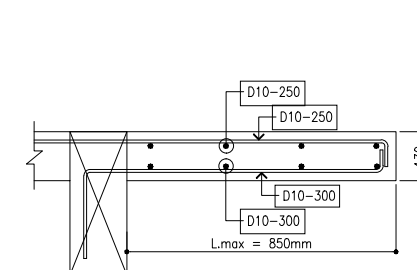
DETAIL PEMBESIAN SLAB LT.16 (REFUGE)
